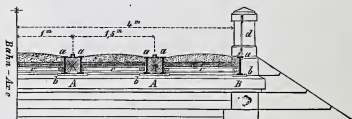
Eisenbahnbrücke mit massiven Zwillingsträgern.
